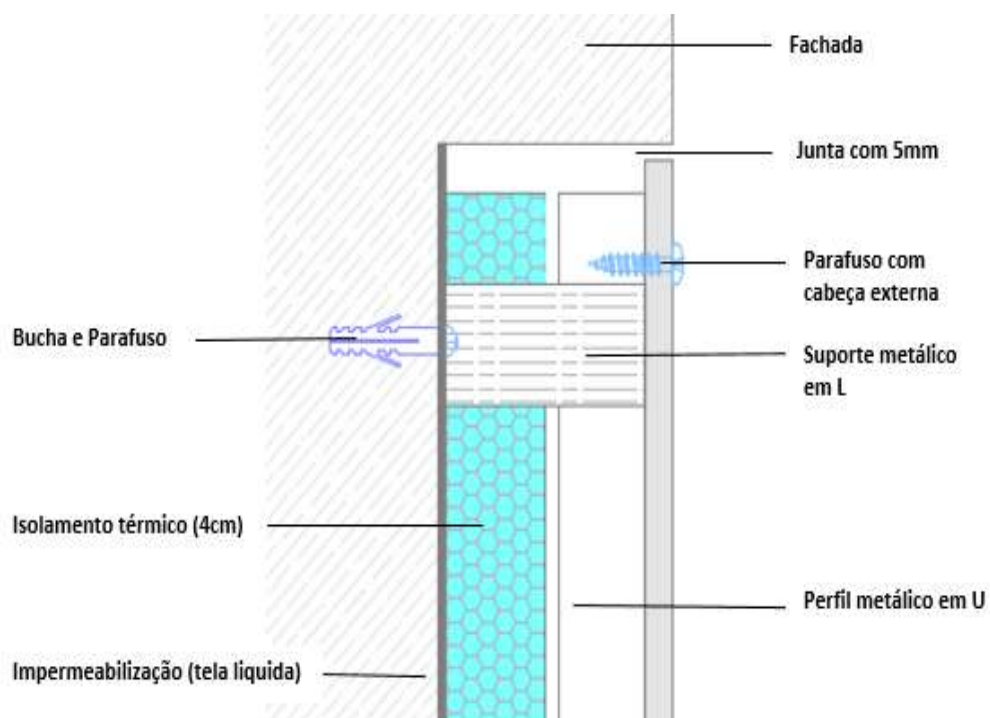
Pormenor construtivo nº3, bordo superior.
